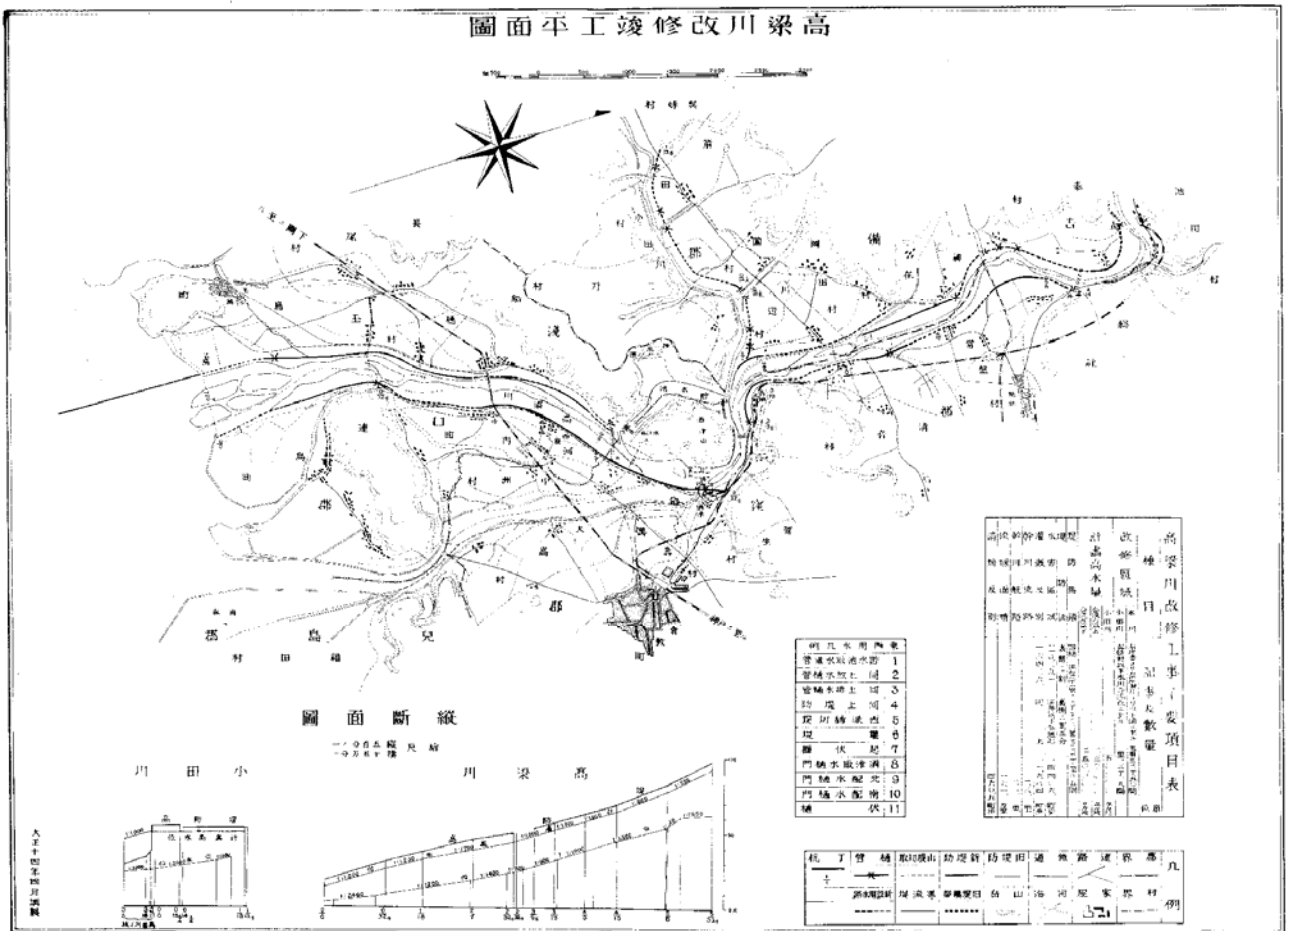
高梁川改修竣工後平面図(T14.4・内務省)
